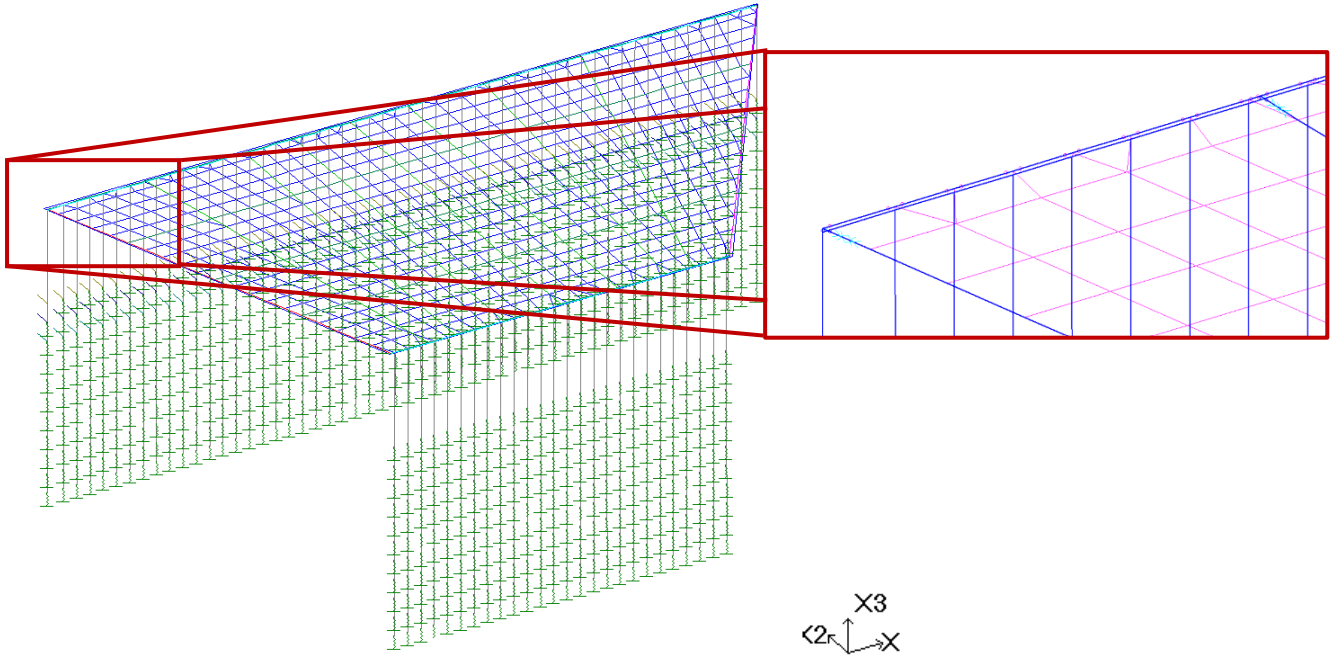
MODELO DA PONTE, RETIRADO DO STRAP
